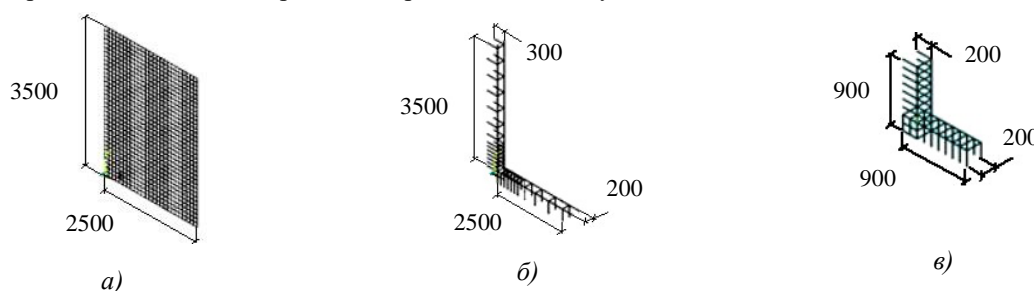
Конструктивные элементы дискретного армирования: а — фоновое верхнее/нижнее армирование; б — армирование ригелей; в — армирование капители (рисунок авторов)
